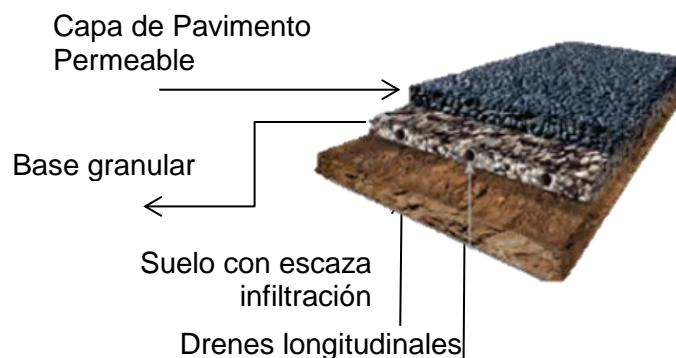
Pavimento permeable con sistema de infiltración parcial con drenaje longitudinal.
